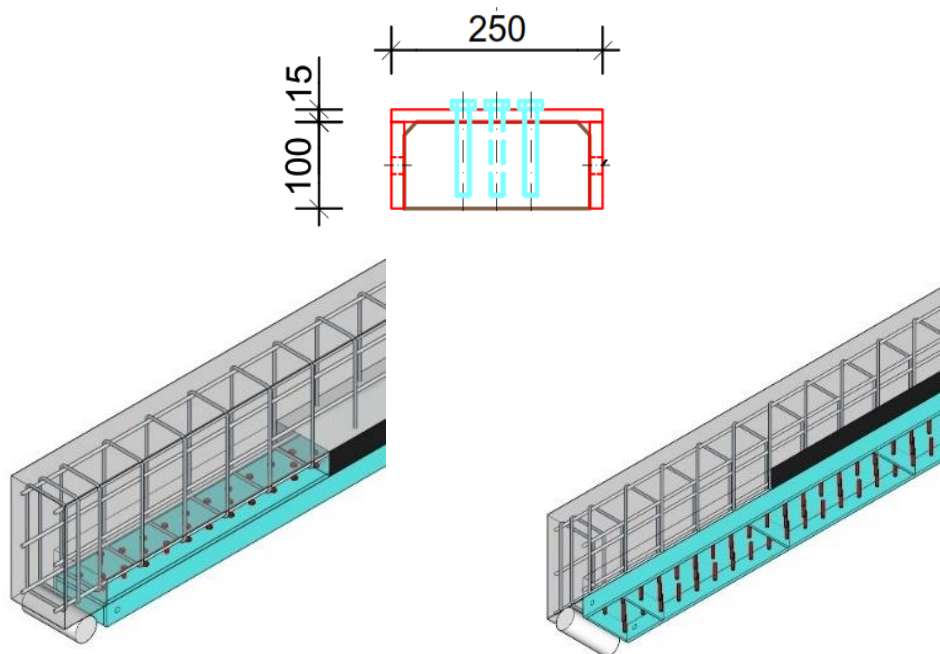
Sección metálica (a), vista superior (b) e inferior (c).
